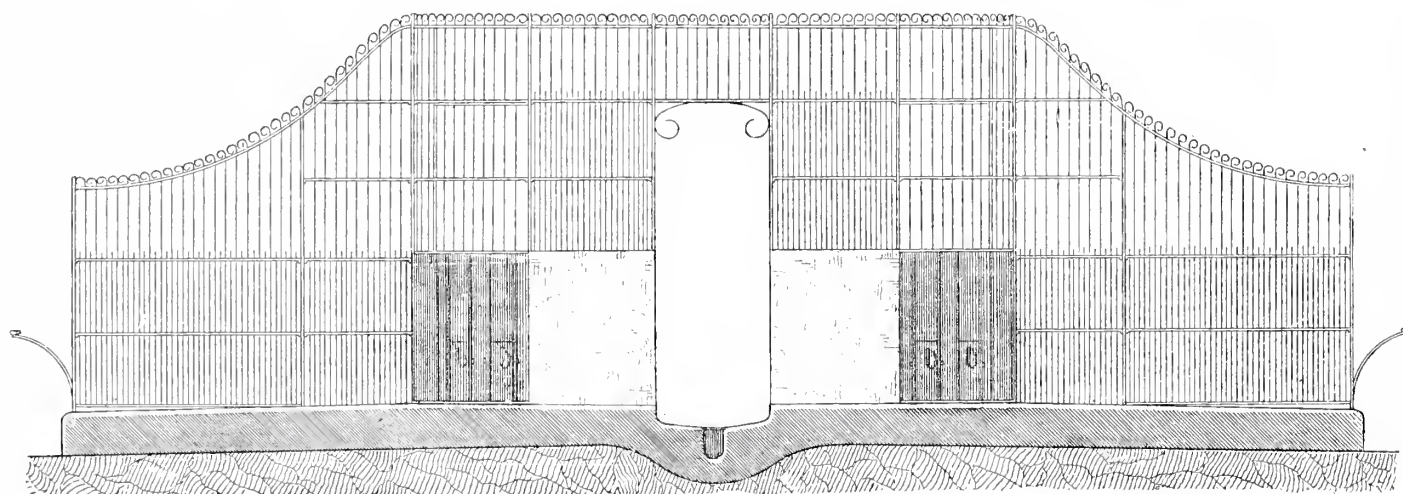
Coupe suivant CD du plan (fig. 1).
